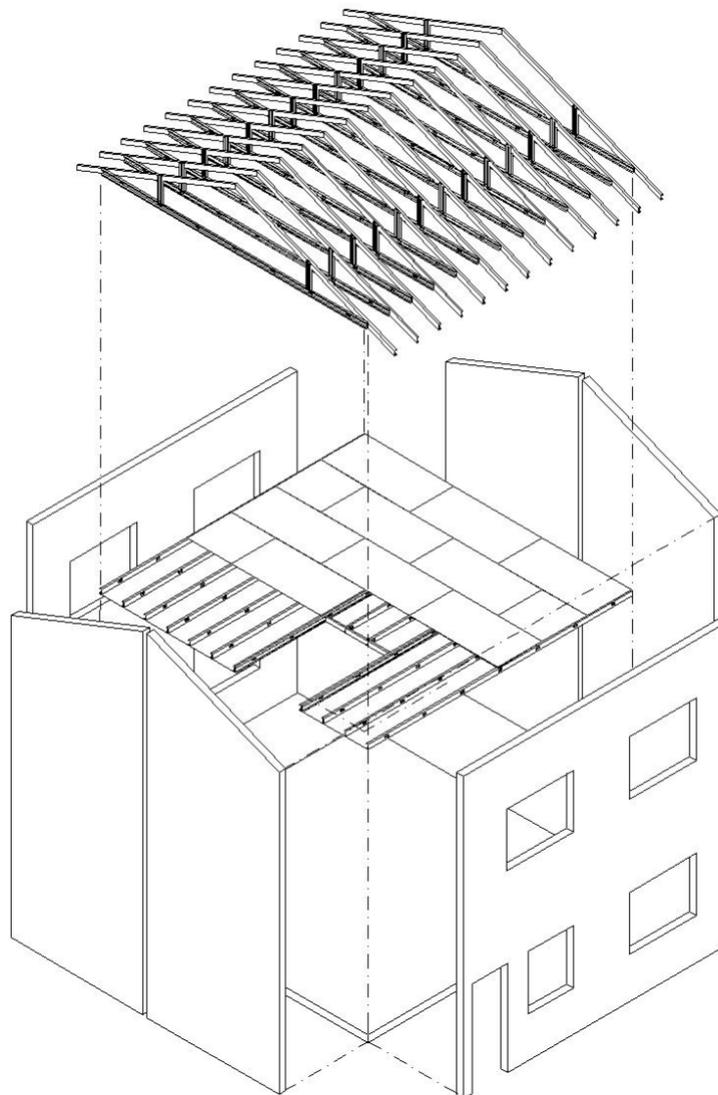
Esquema de construção tipo “balloon”. Fonte: Grubb e Lawson, 1997.
